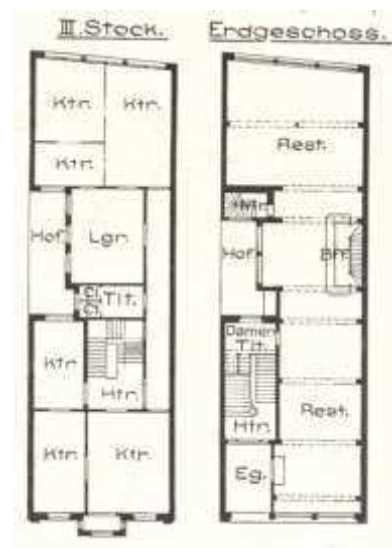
Geschäftshaus Alterwall 26. Abb. 53b: Grundrisse.
